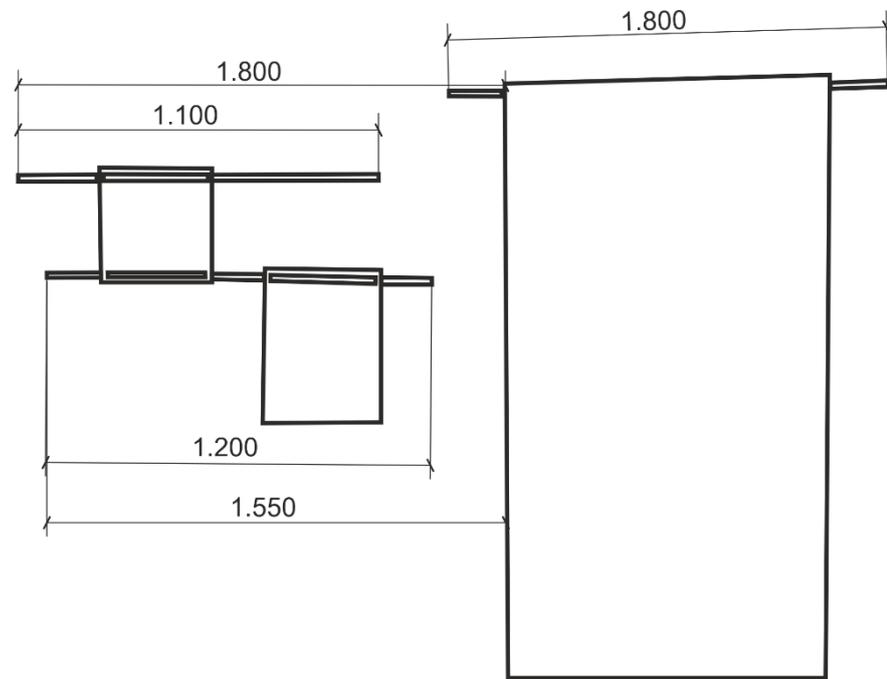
Dimensiones de las piezas y disposición en la pared.
